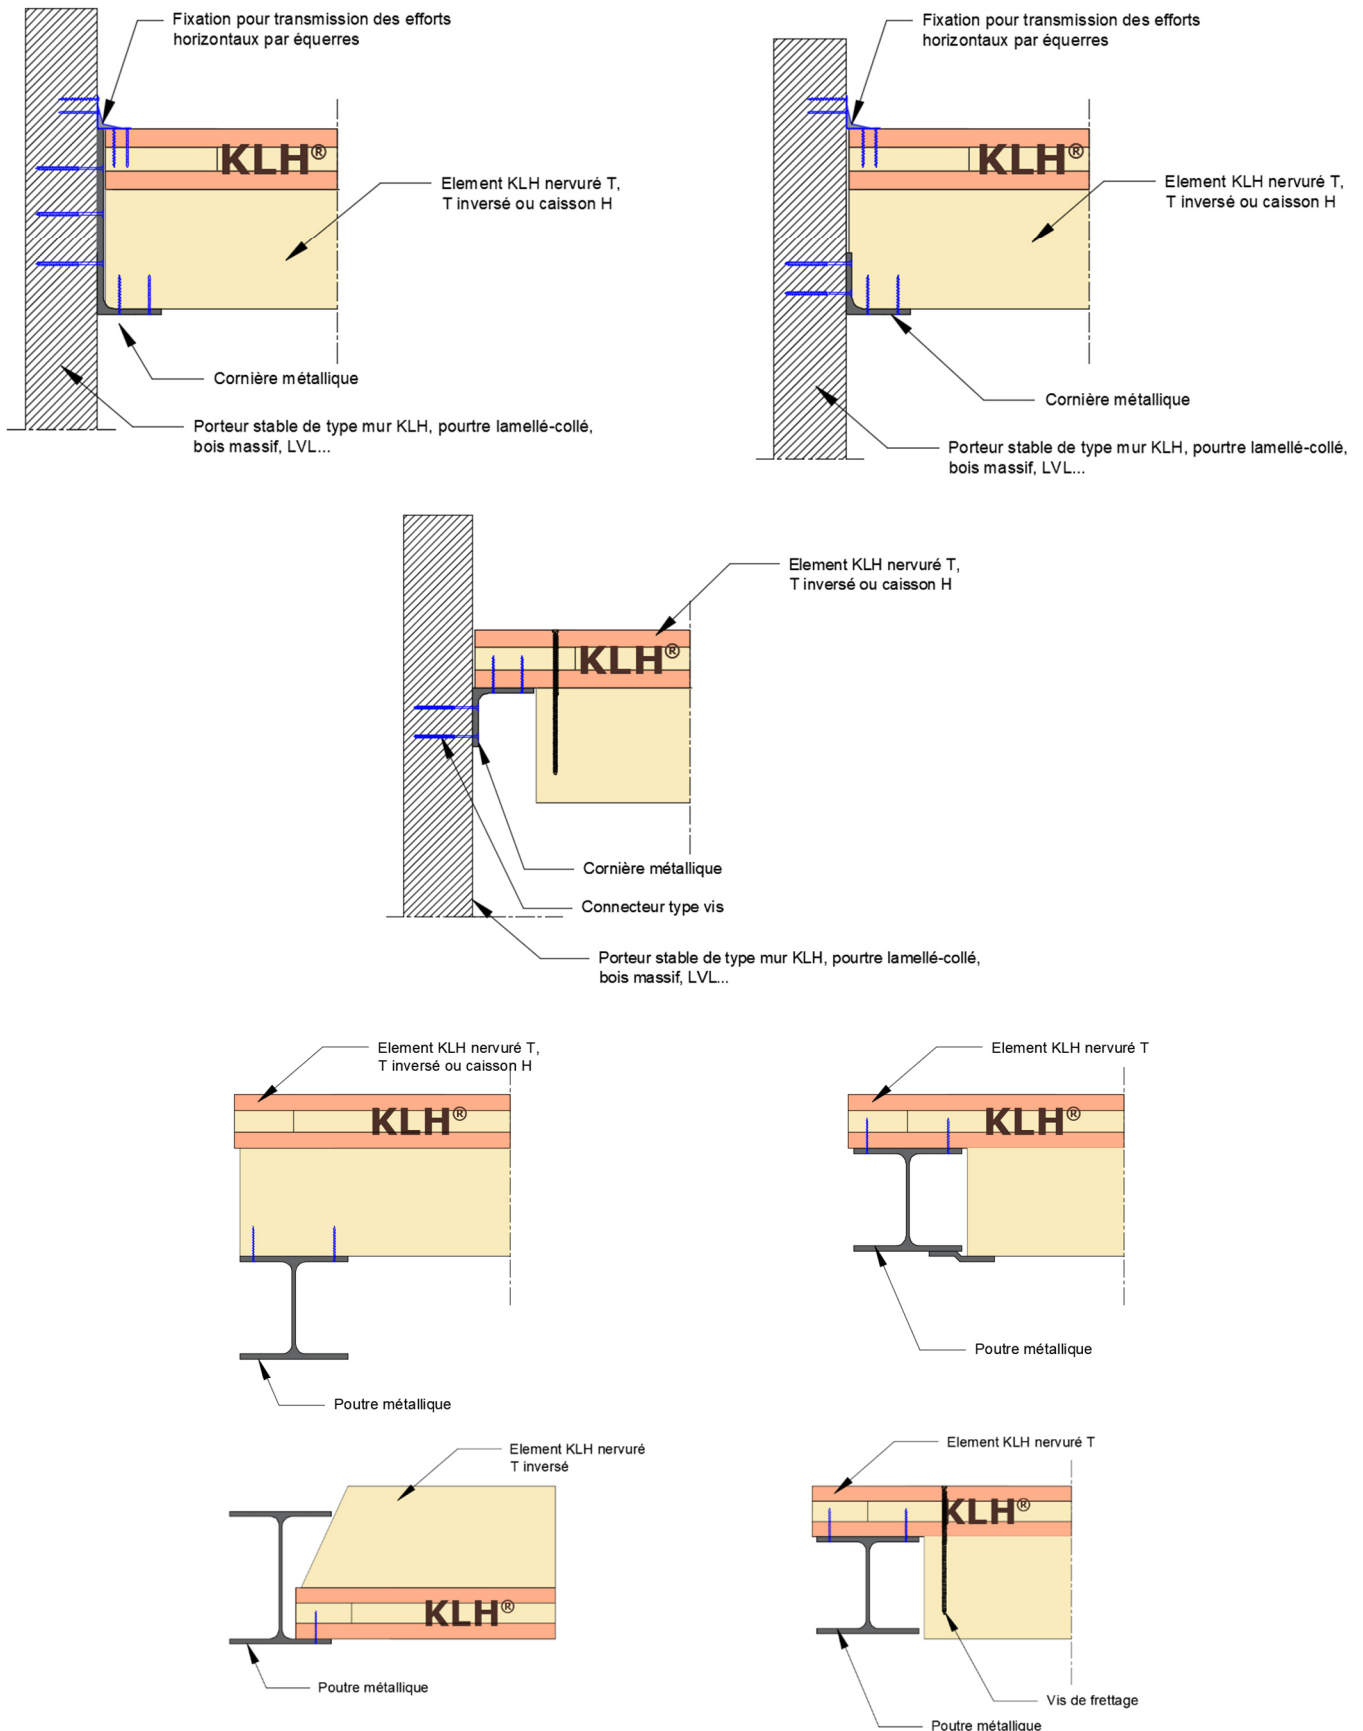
Détails d'appuis usuels sur poutres métalliques
